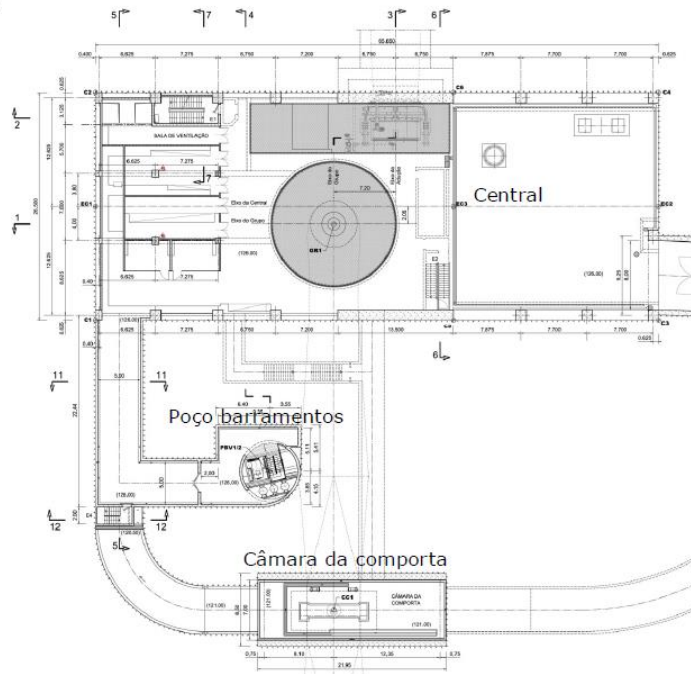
Planta da caverna subterrânea da central hidroelétrica [14].
